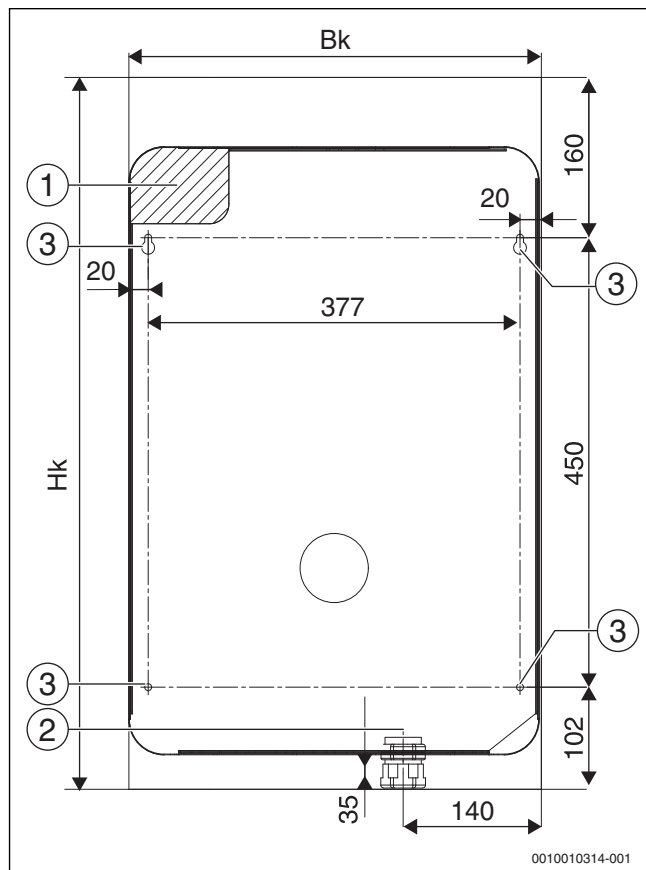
Abmessungen der Bohrungen für das Befestigen des Heizkessels an der Wand und für das Versorgungskabel beim Heizkessel Tronic Heat 3000 15-24 kW
